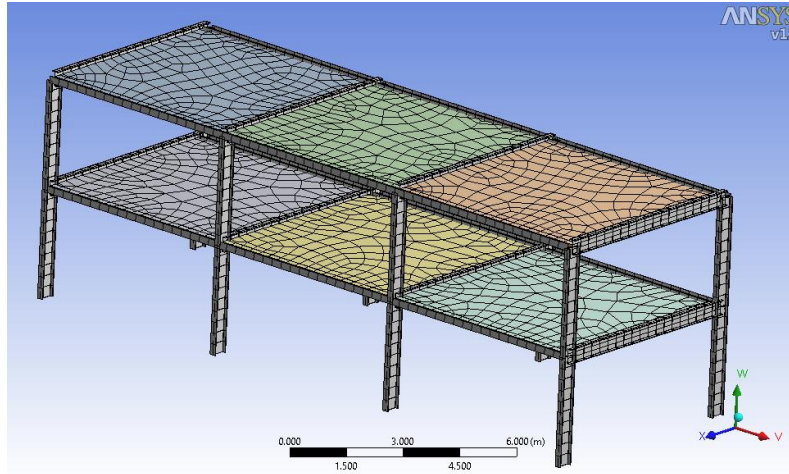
Çok katlı yapı prototipin taban beton karışımının oluşturulması (6 beton taban)
